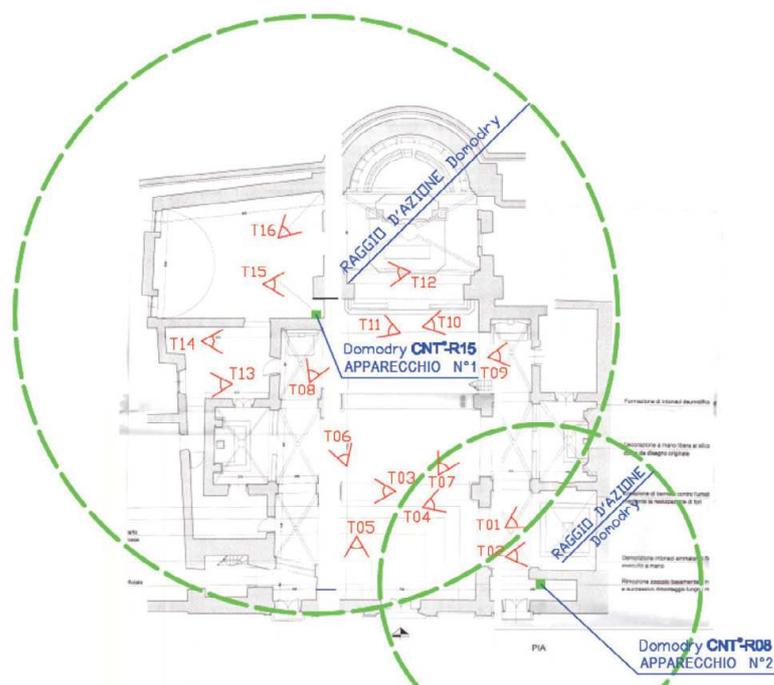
Schema planimetrico dei dispositivi CNT installati nel marzo 2011
